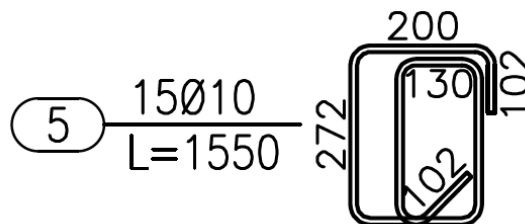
Dettaglio armatura di frettaggio giunto longitudinale
